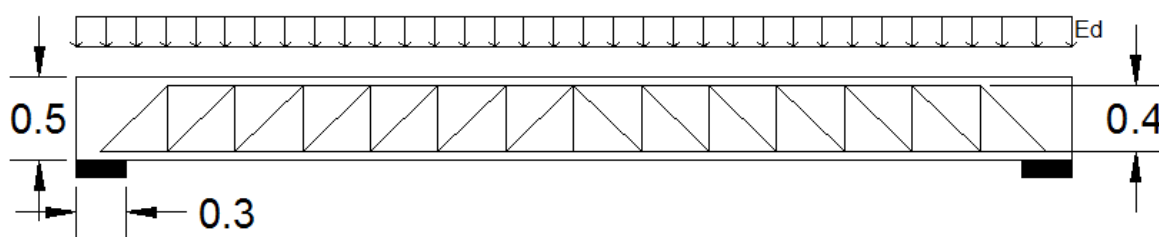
Modelo de escoras e tirantes adotado para a *Viga 1*.
